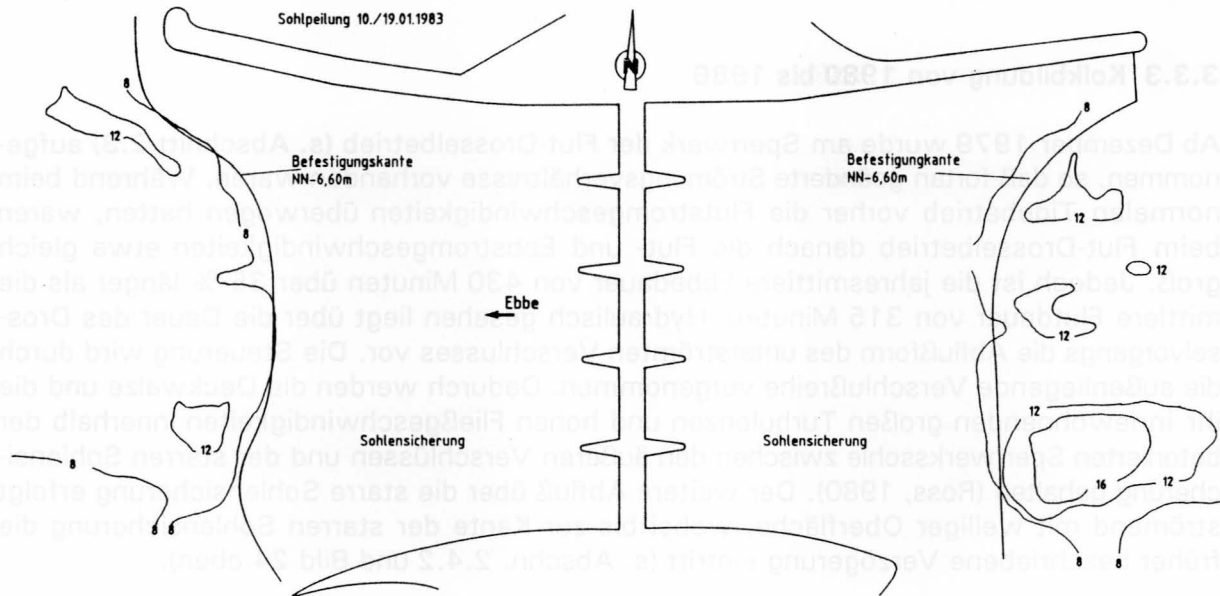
Lageplan der Kolke mit Tiefen in m unter NN. Zustand Januar 1983
